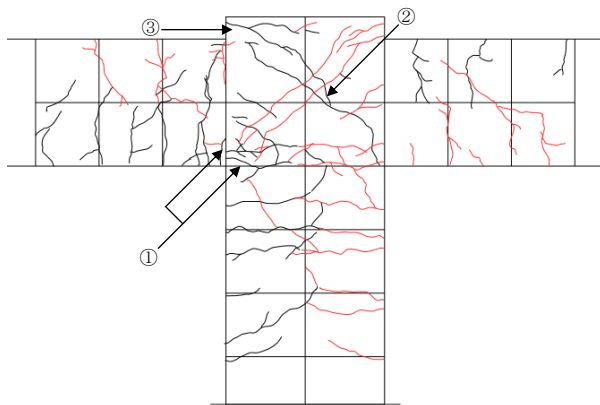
ひび割れ状況(No.8 $R=1/50\text{rad}$)
